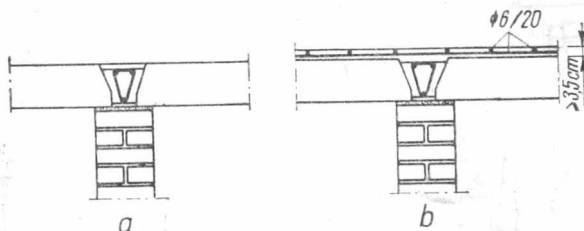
Centuri la planșee din elemente prefabricate :
